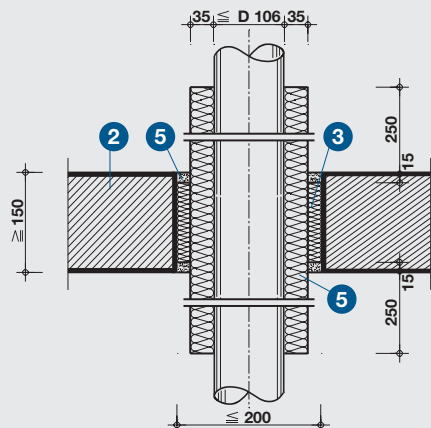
Detaily E až H znázorňují utěsnění vstupů potrubí stropu tl. min. 150 mm. Provedení je obdobné jako v detailech A až D.
